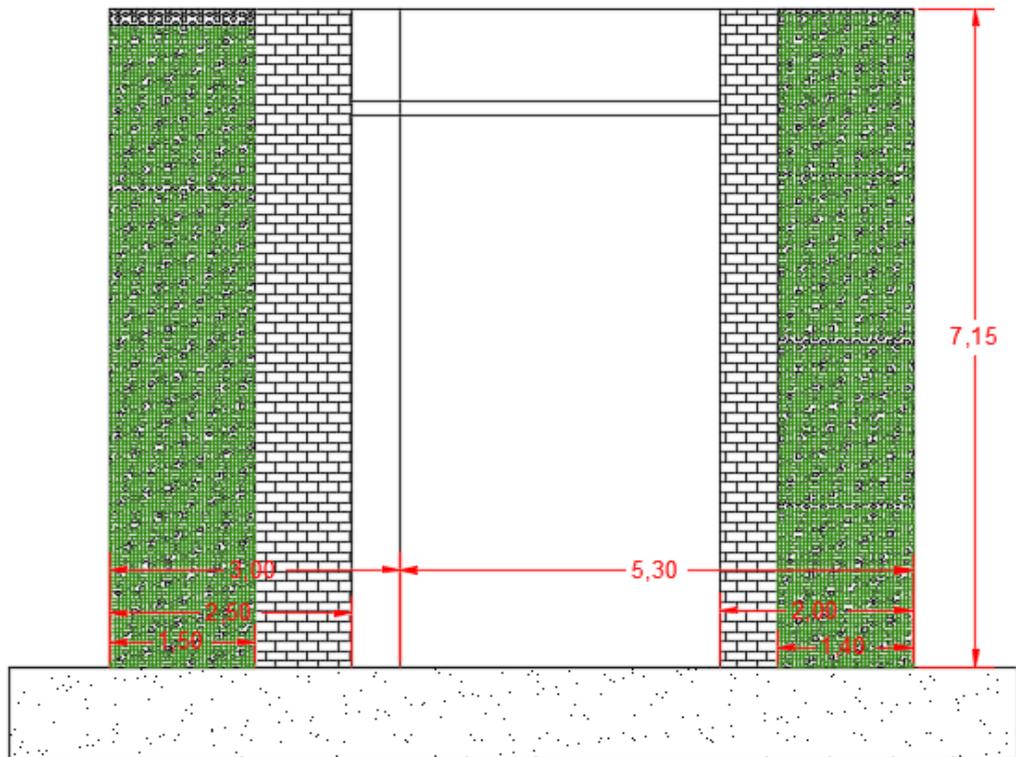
Fachada com brises e plantas (jardim vertical). Fonte: elaborado pelo pesquisador, através do software CAD.
